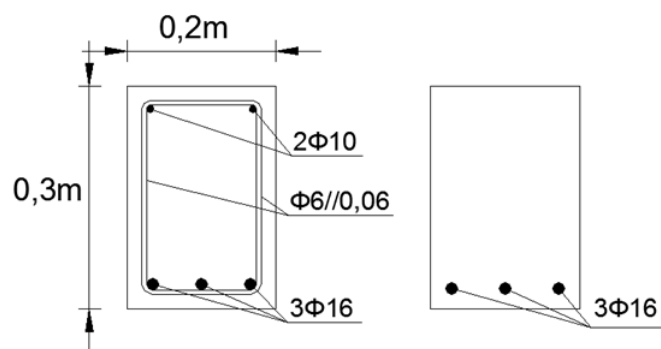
Secção transversal da Viga4old nas zonas laterais e central.
